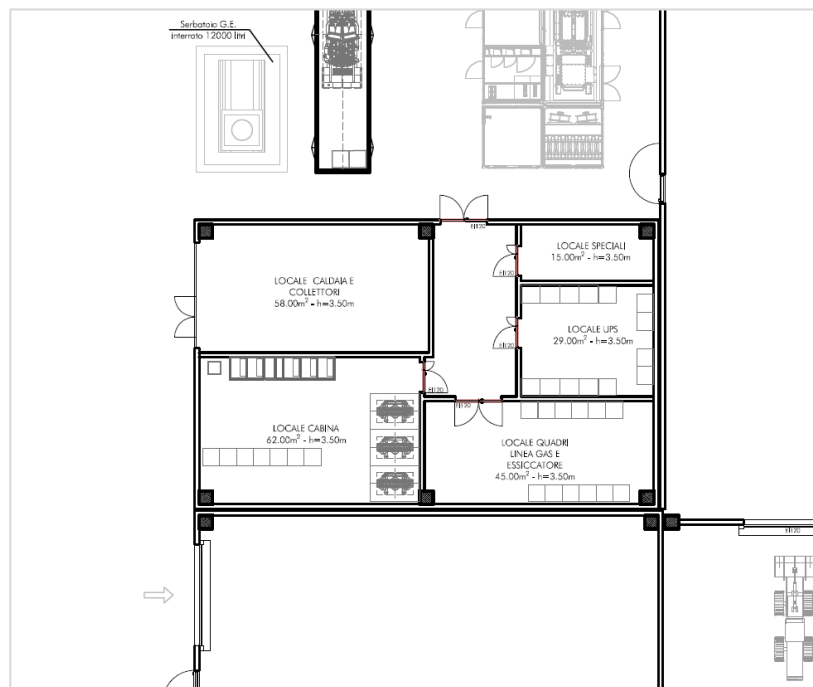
Locale tecnico multi-funzione_ Stralcio dalla planimetria generale
